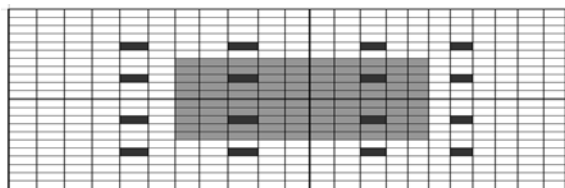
Расчётная область с планом армирования сваями (вид сверху)
